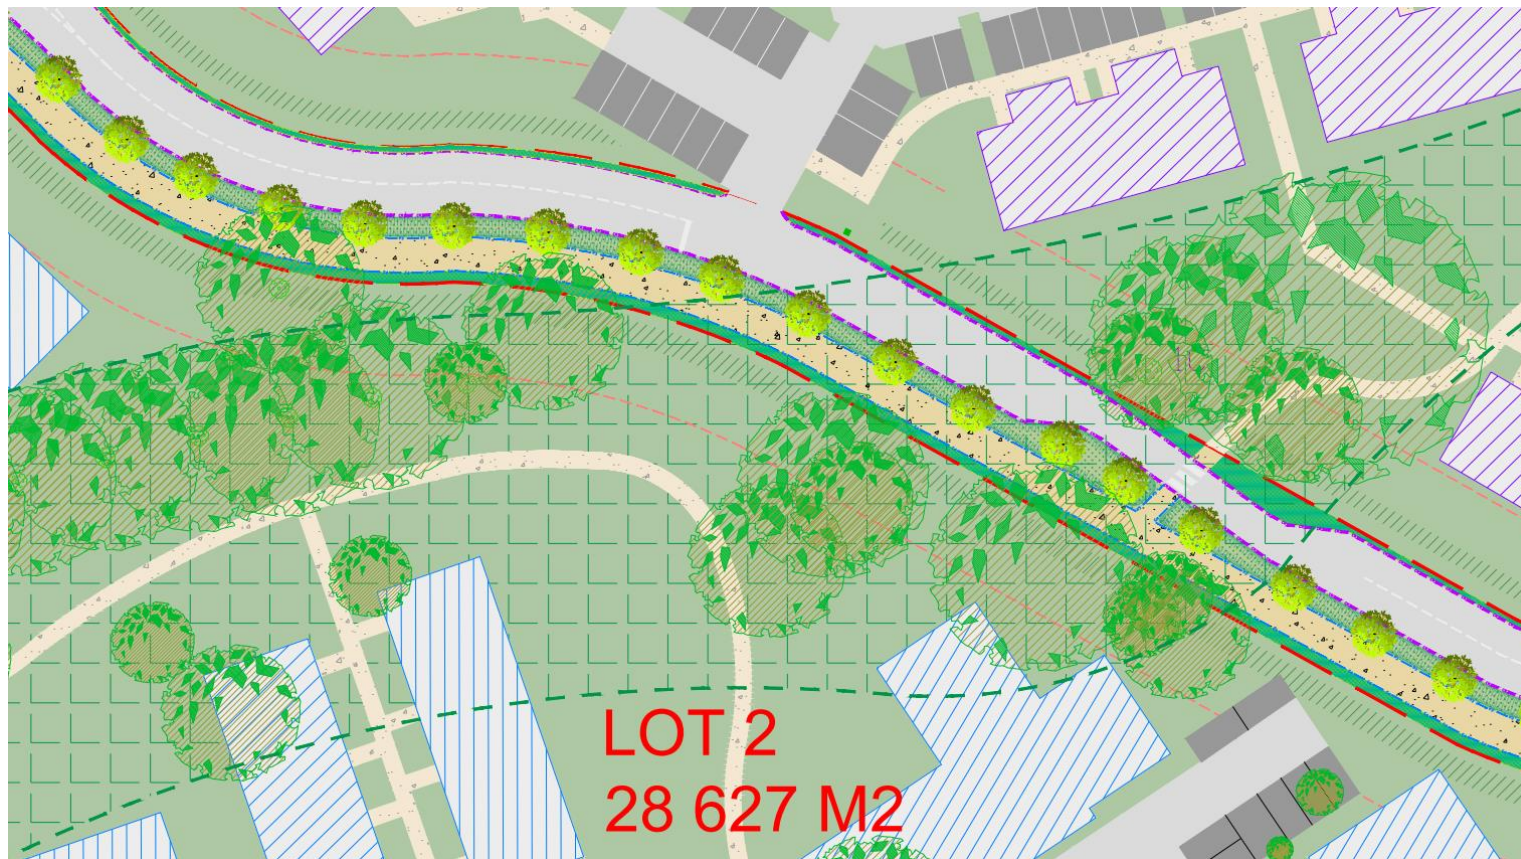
Zoom sur la coulée verte préservée (plan géomètre 2023)
